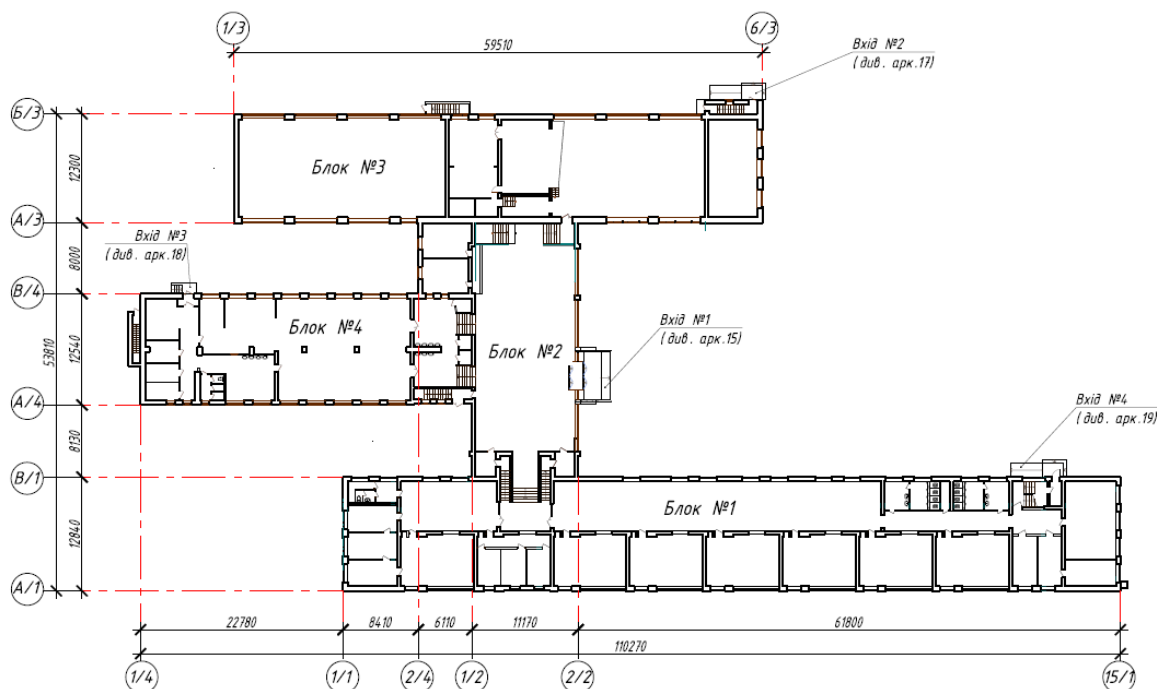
Встановлений план першого поверху будівлі (за результатами проведених обмірів приміщень будівлі).
